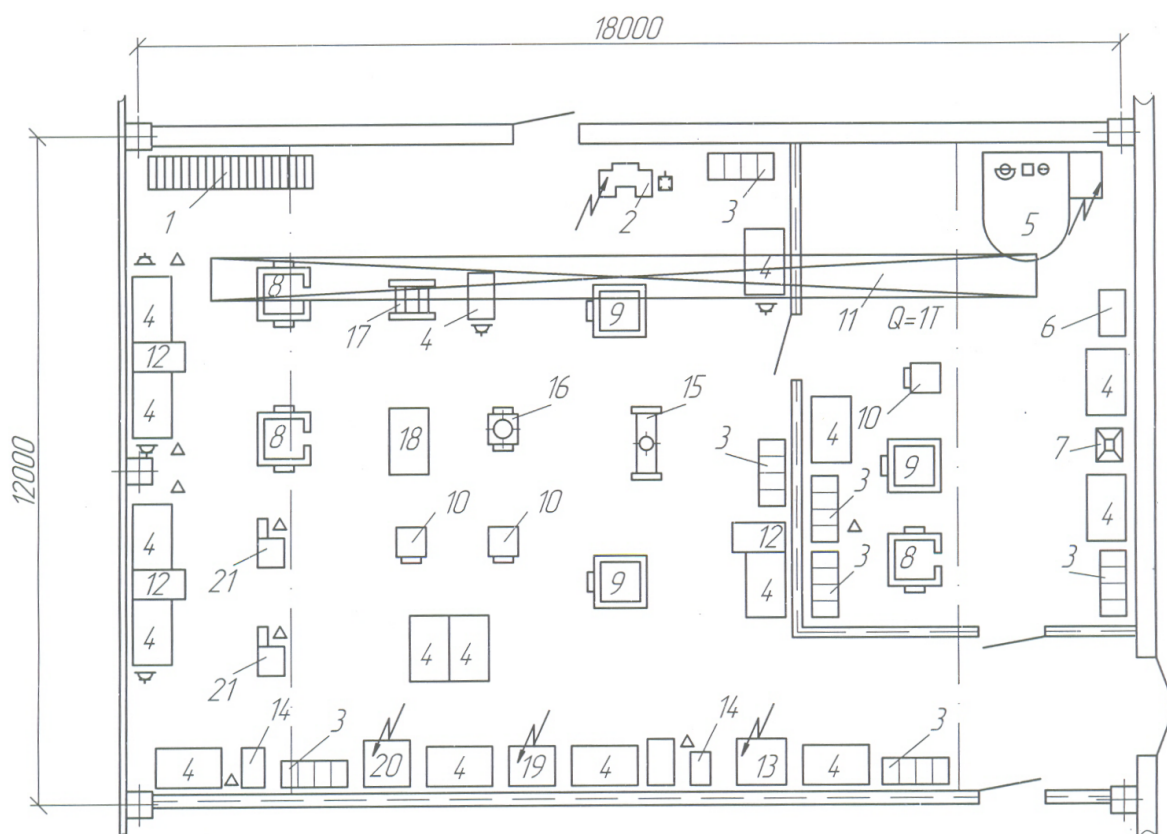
Агрегатный цех ПЦТО для грузовых автомобилей:
